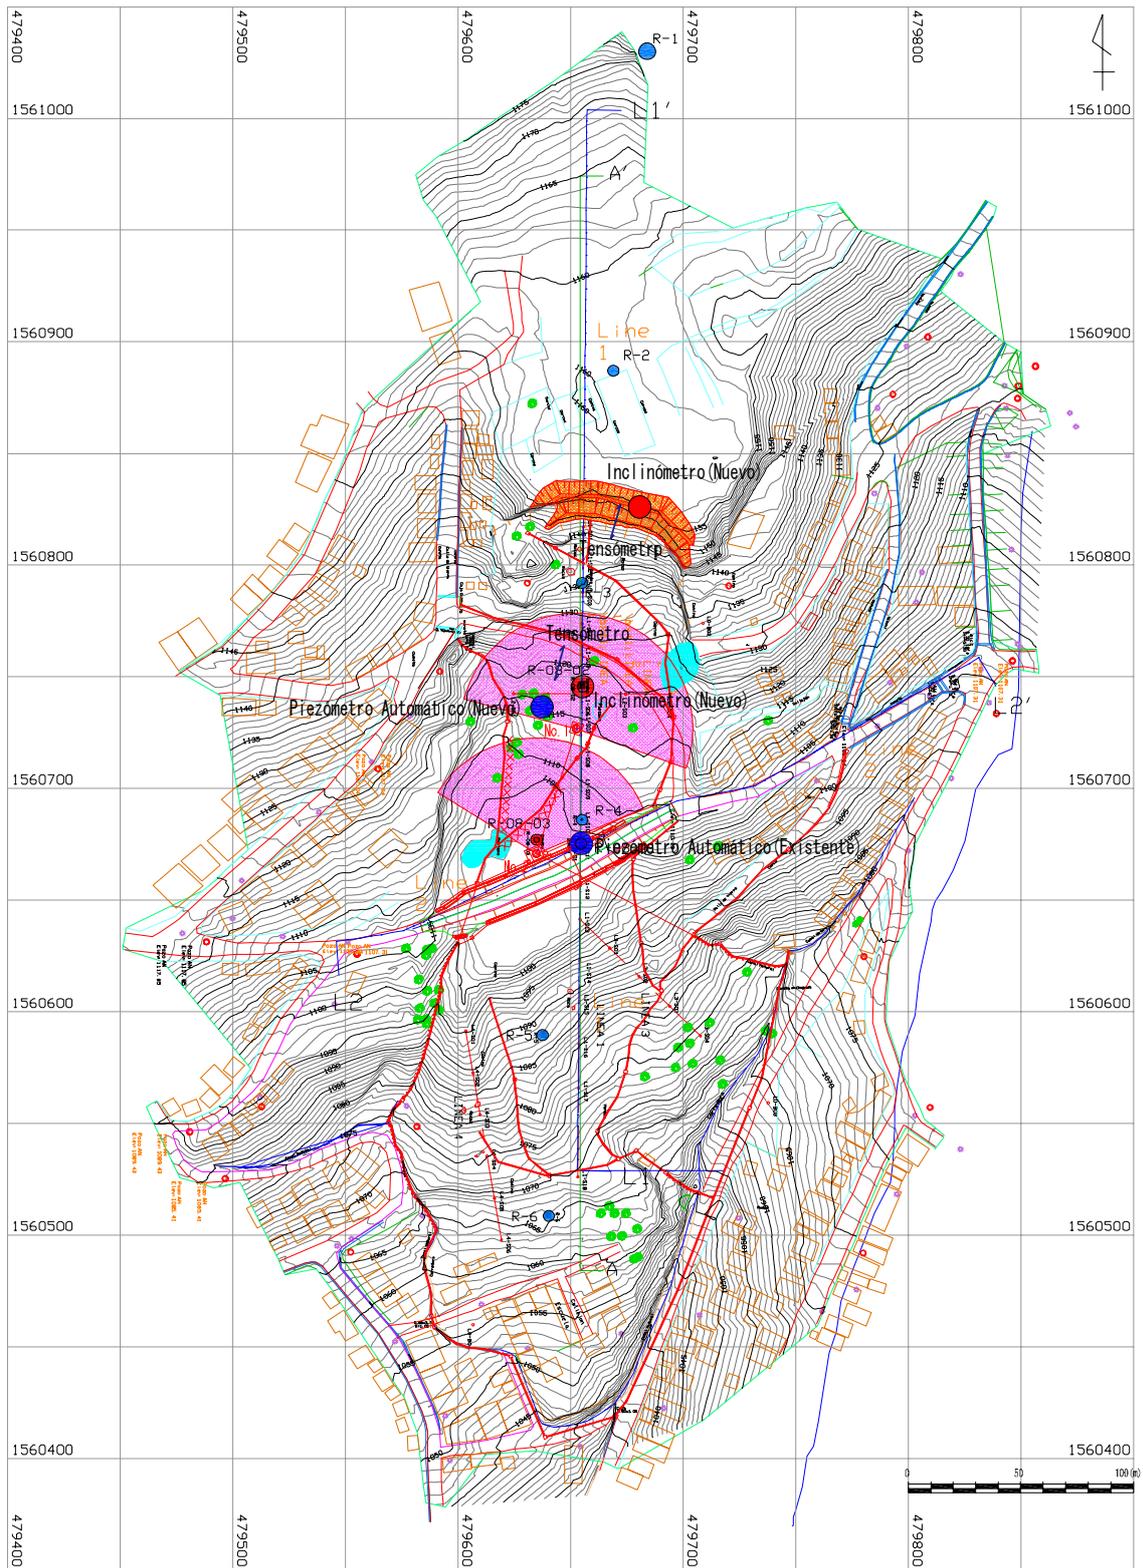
Vista en Planta Planificada de Obras Preventivas de El Reparto
